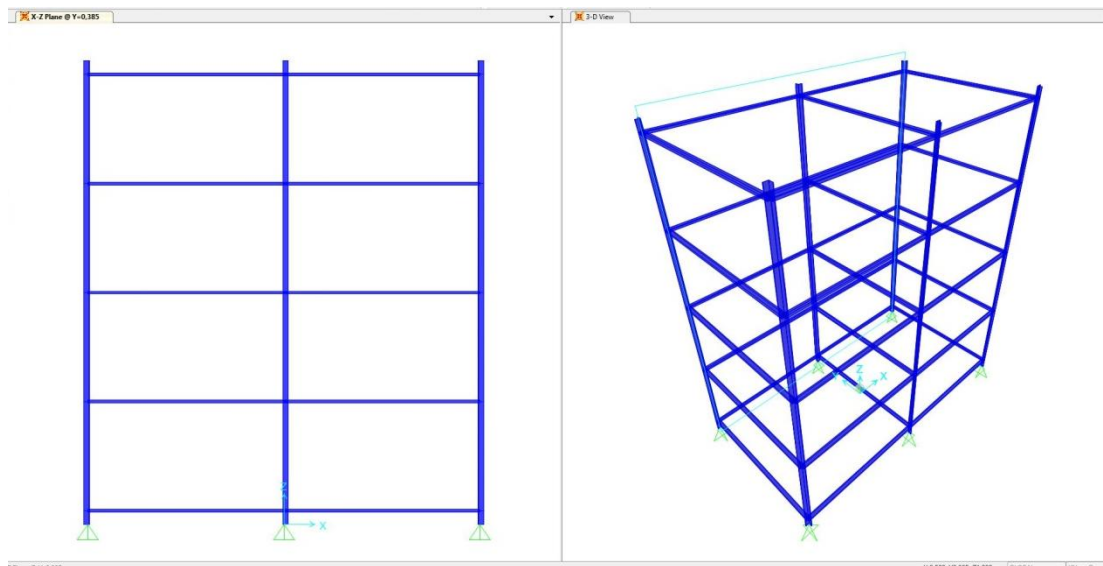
Captura de pantalla del programa SAP2000 donde se muestra el modelo en 2-D y 3-D con las secciones de columnas y vigas asignadas.
